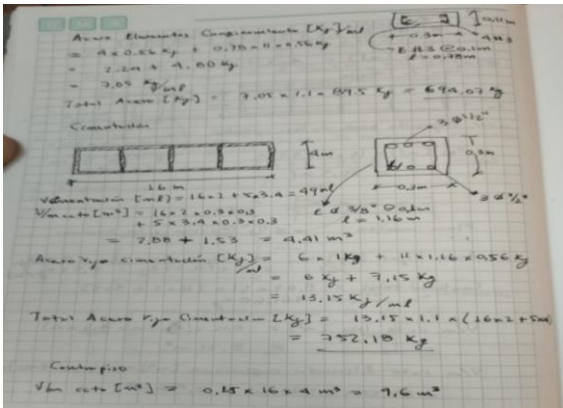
esquema de plano cimentación y planta de localización de columnetas
